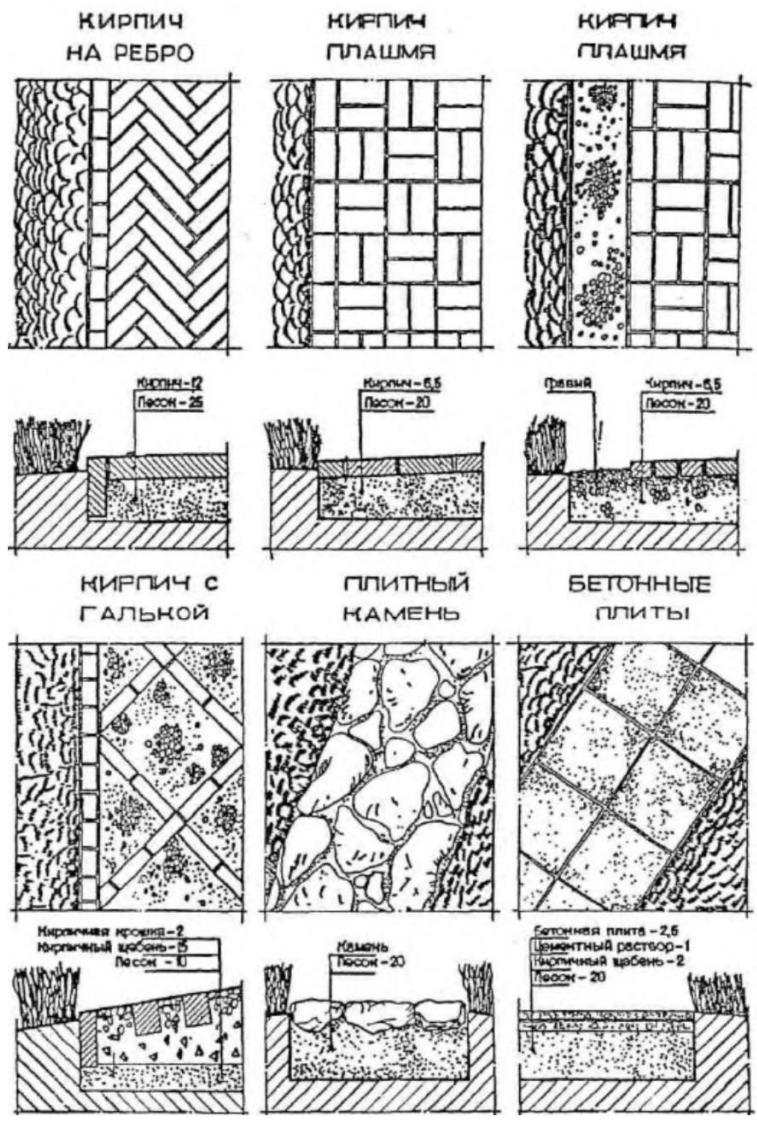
Конструкции садово-парковых дорожек с разными типами покрытий
